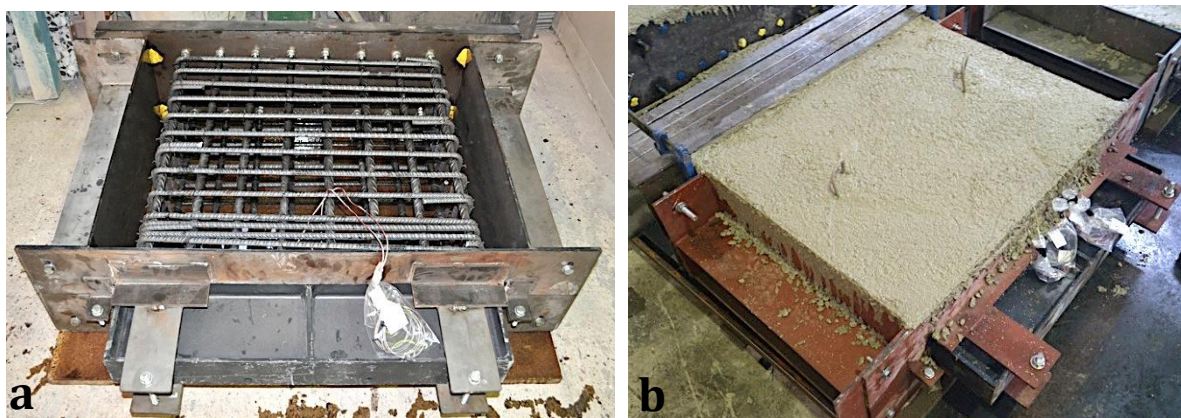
Aplicación del líquido desencofrante (a), hormigonado y colocación de ganchos (b).
